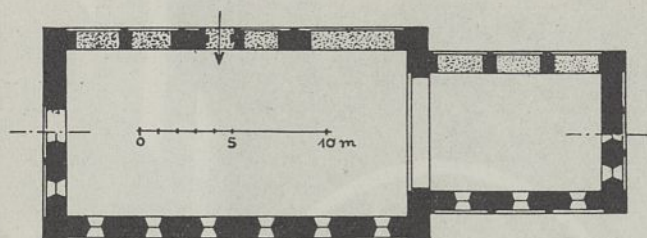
Jerichow, Pfarrkirche. Grundriß.
